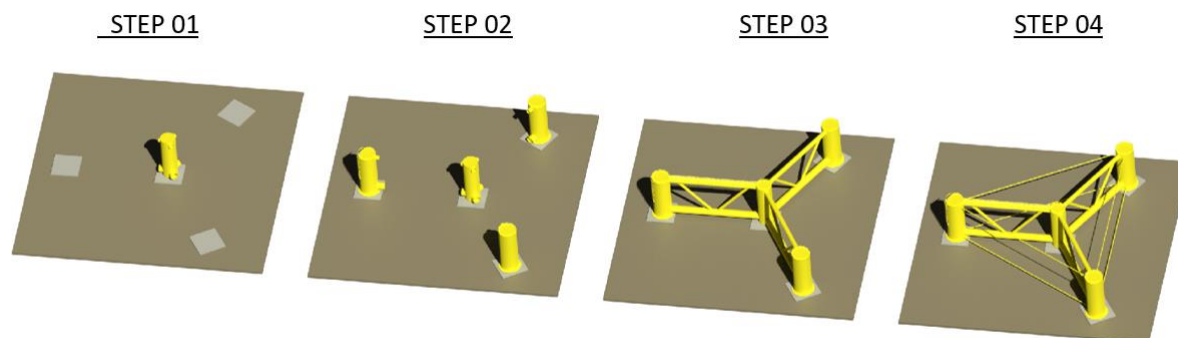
Sequenza di assemblaggio della fondazione galleggiante.
